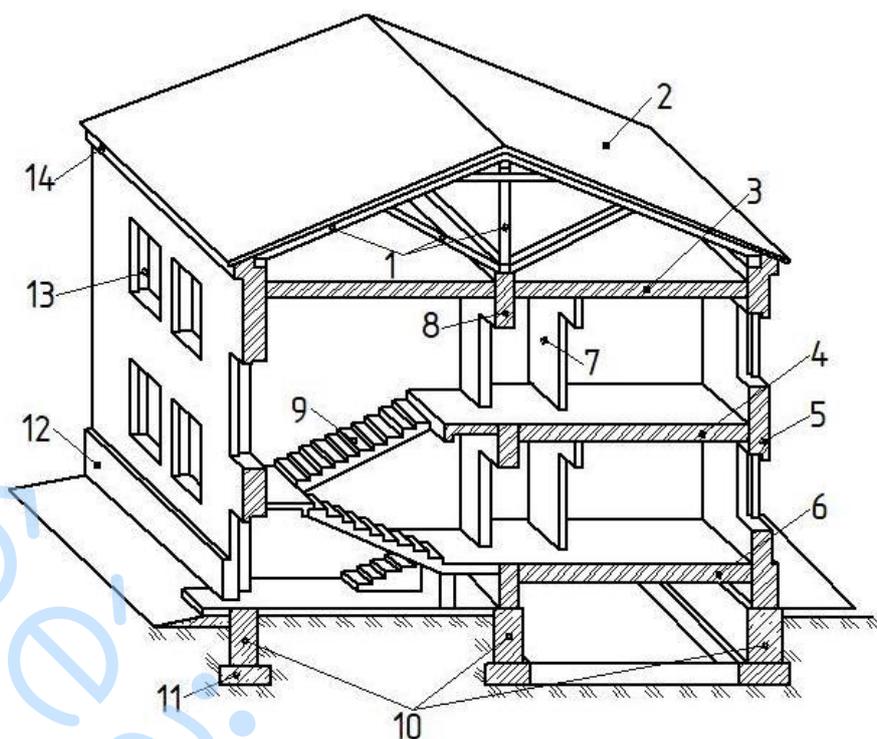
Схема расположения перекрытий в стеновой конструктивной системе:
